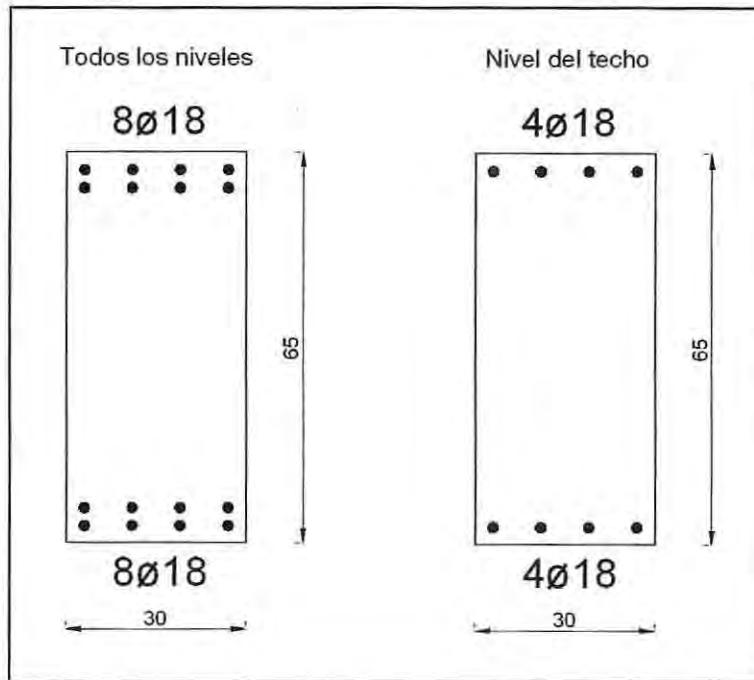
Disposición del refuerzo longitudinal en vigas.
